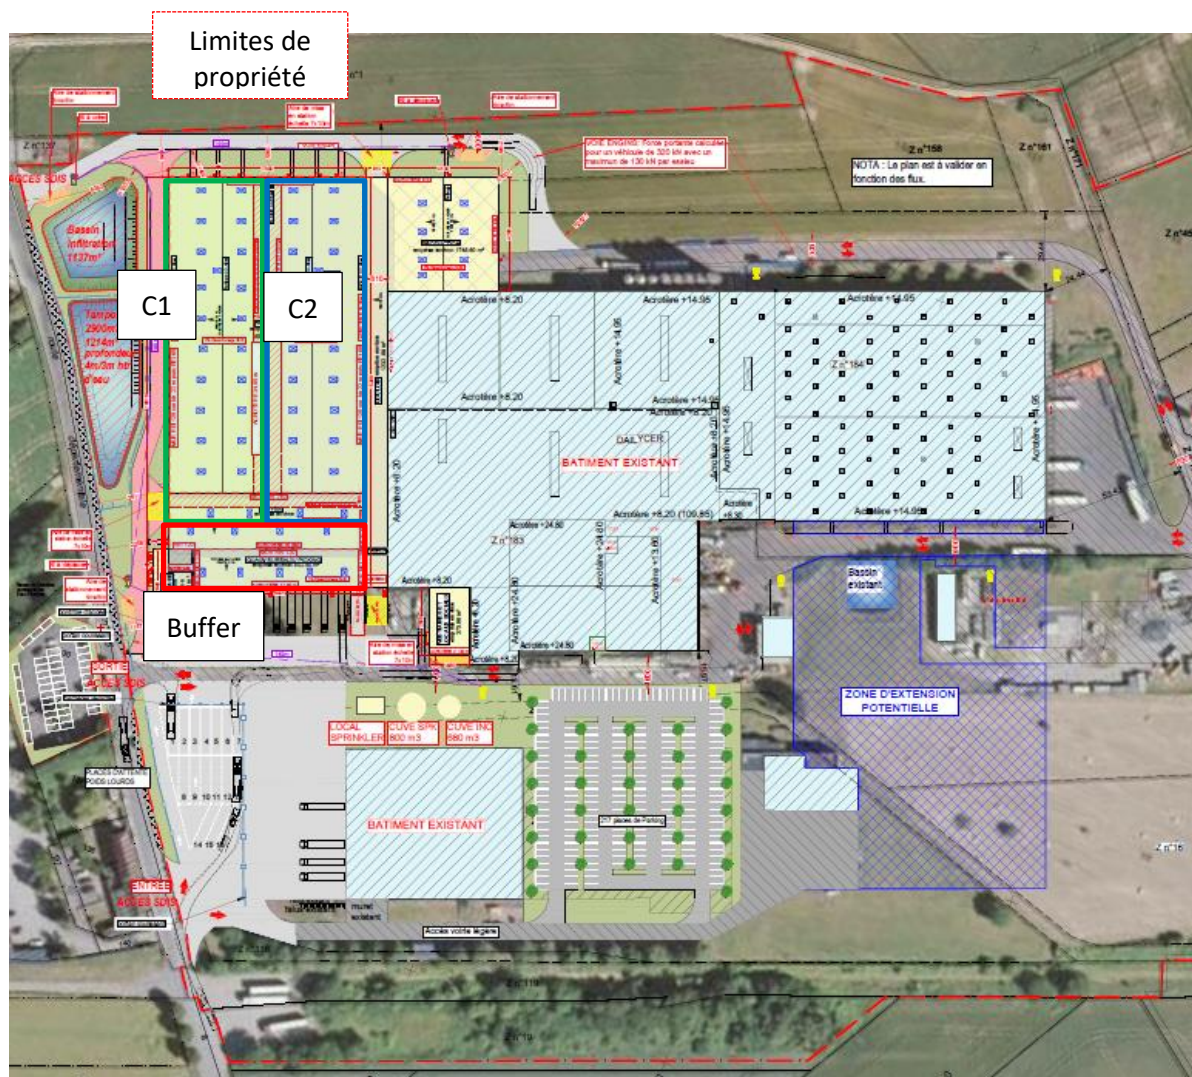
Plan de masse du projet d'entrepôt Dailycey
